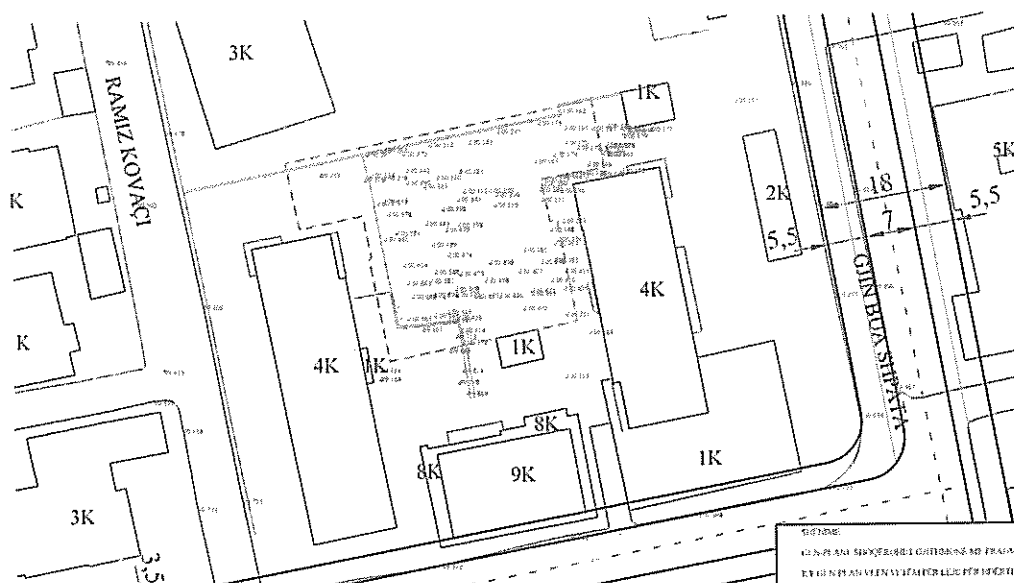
FRAGMENT NGA PLANIMETRIA E TIRANËS, ZK.8270, TR; R-10
